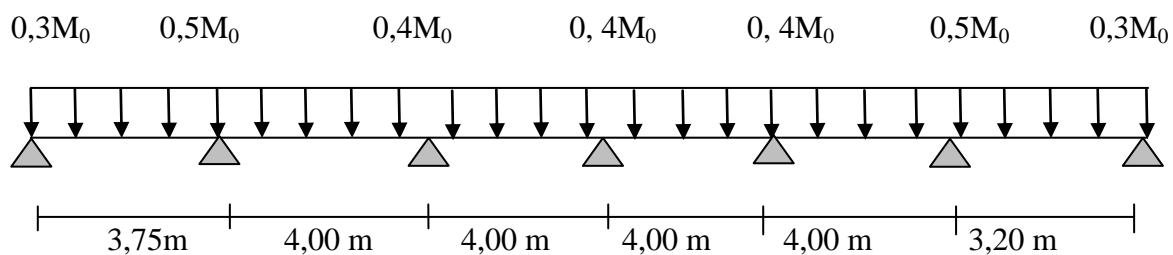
schéma statique d'une poutre sur plusieurs appuis
